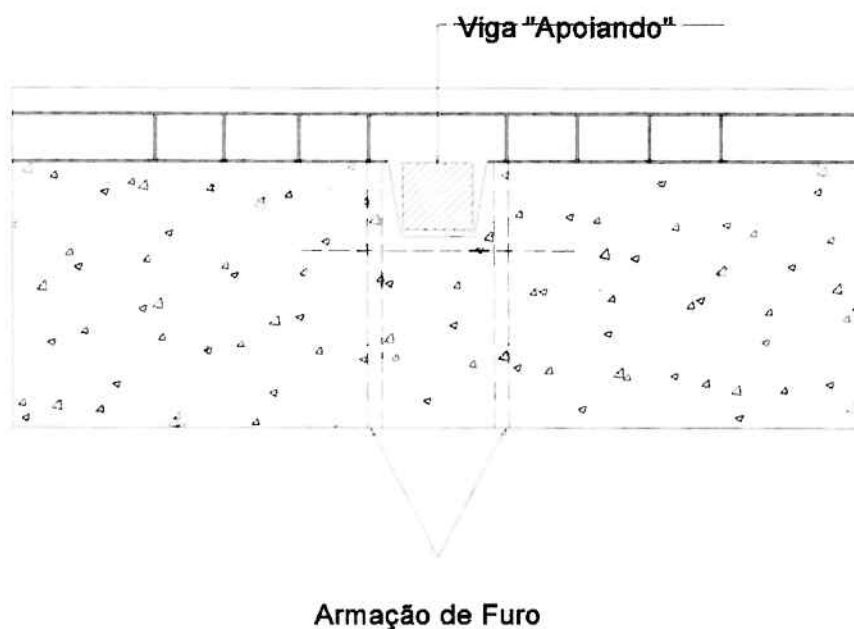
Ligação pré-viga com pré-viga que serve de apoio
